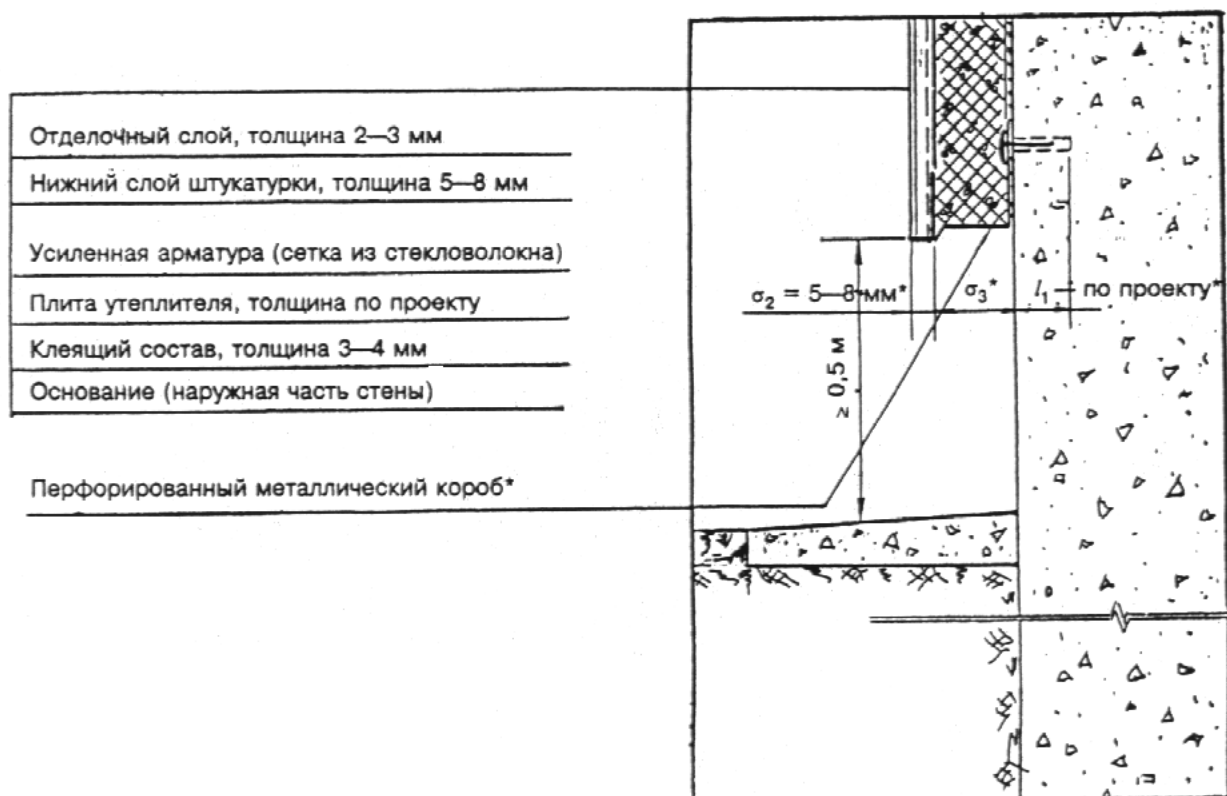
Крепление теплоизоляционного слоя на нижней части стены
